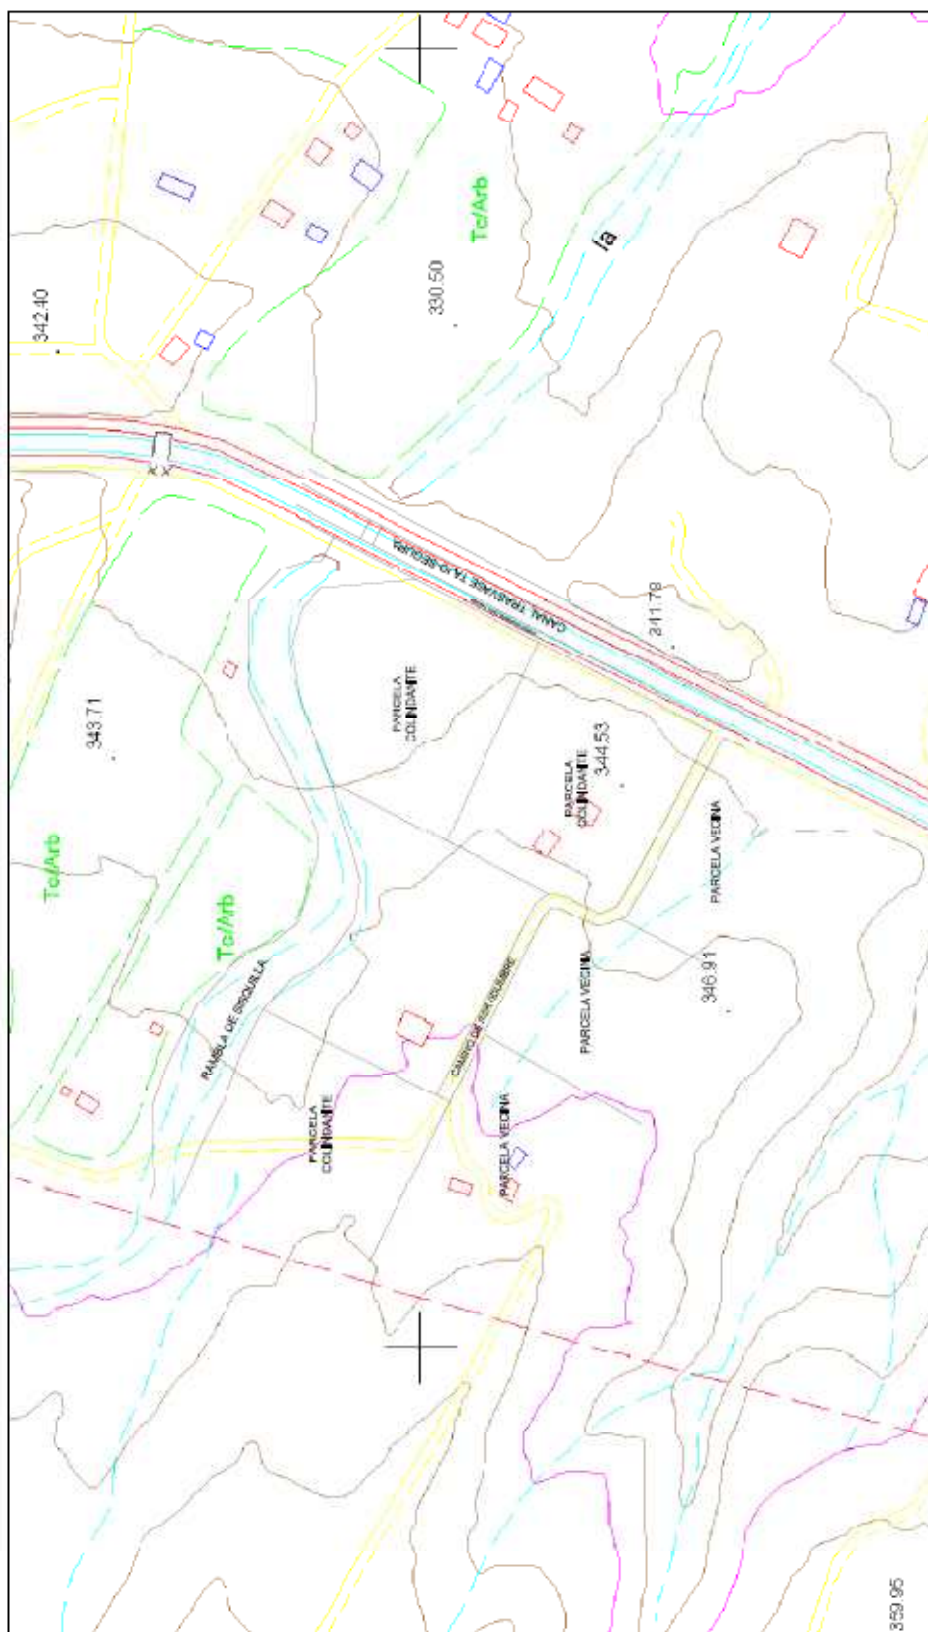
b) Plano nº 5.b): Vivienda unifamiliar rural aislada. Plano topográfico
